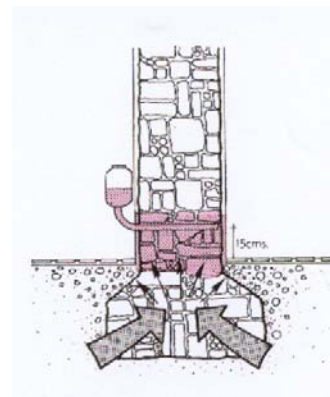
Corte esquemático da execução da barreira de corte hídrico
